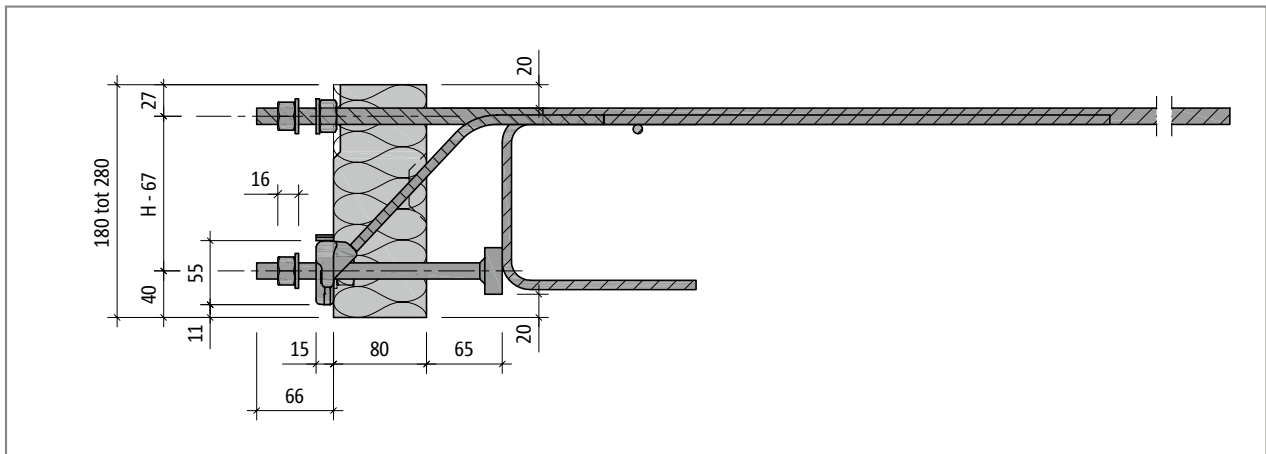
Schöck Isokorb® T type SK-MM2-VV1: Bovenaanzicht
